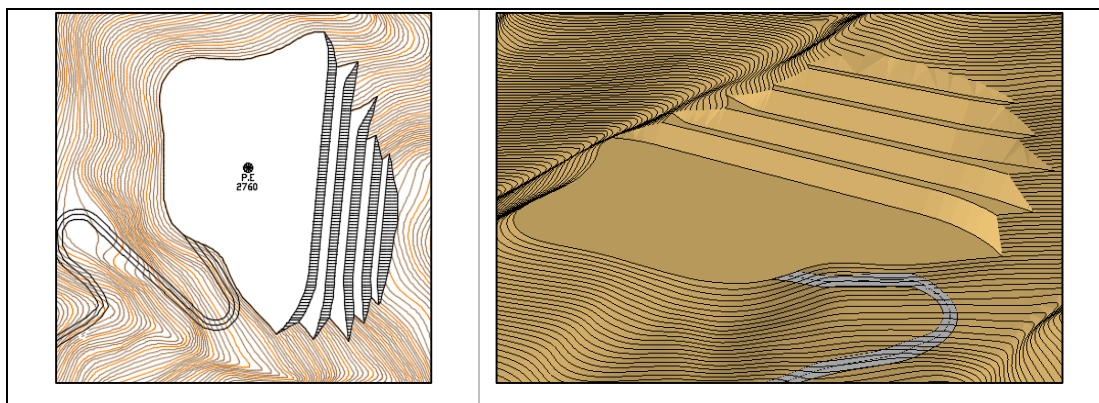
Vista en planta y en 3D de la Fase 5 de explotación.
